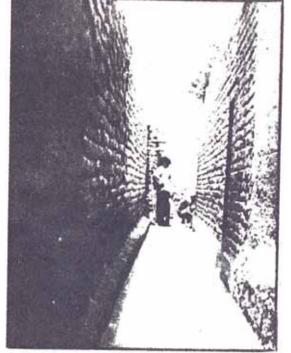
Muro medianero en pésimo estado. BREMA
